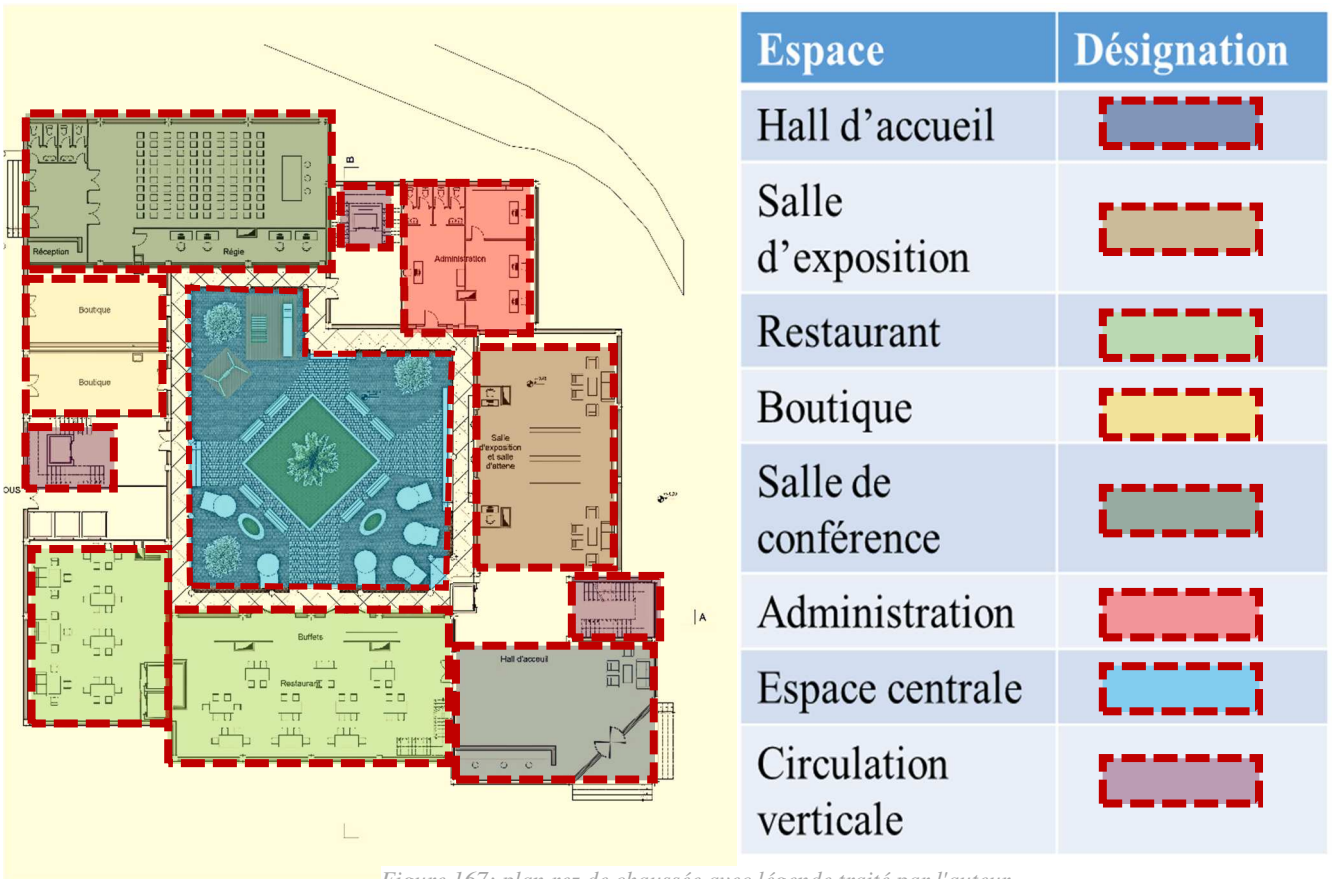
plan rez de chaussée avec légende traité par l'auteur
